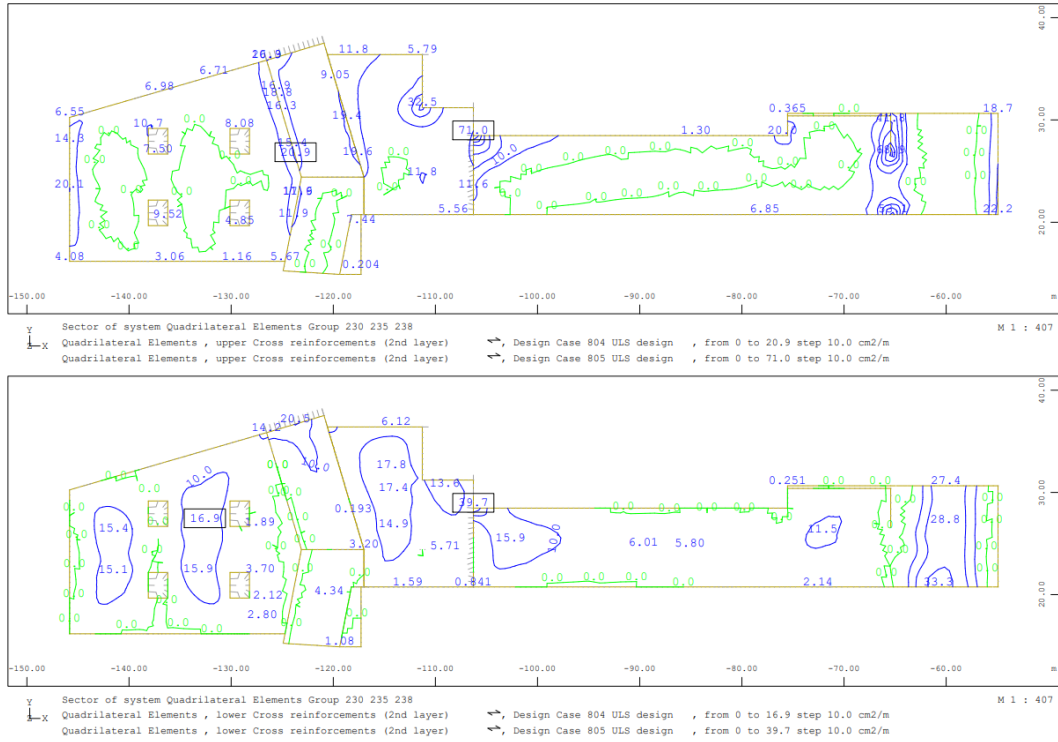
Armadura secundária na face superior (sup.) e inferior (inf.) – laje de cobertura – acesso Norte - ELU
